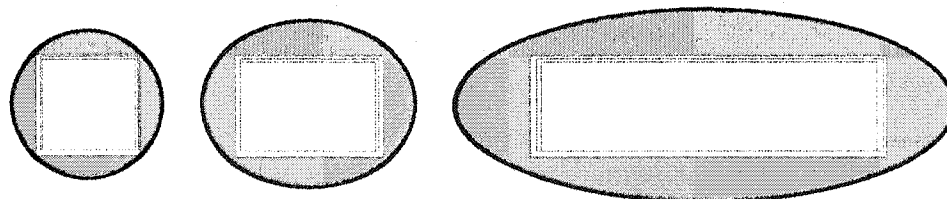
Renforcement pour une pile fortement rectangulaire
